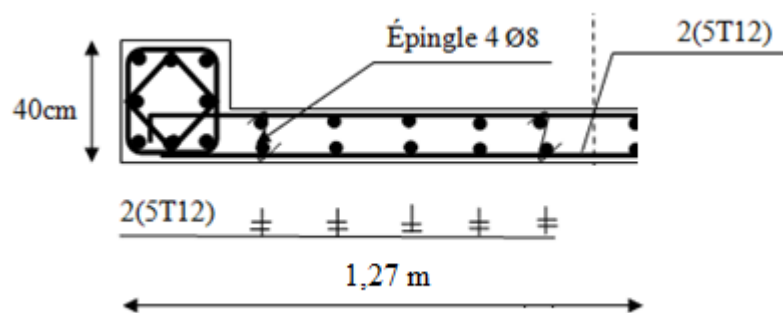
Schéma de ferrailage d'un trumeau.
